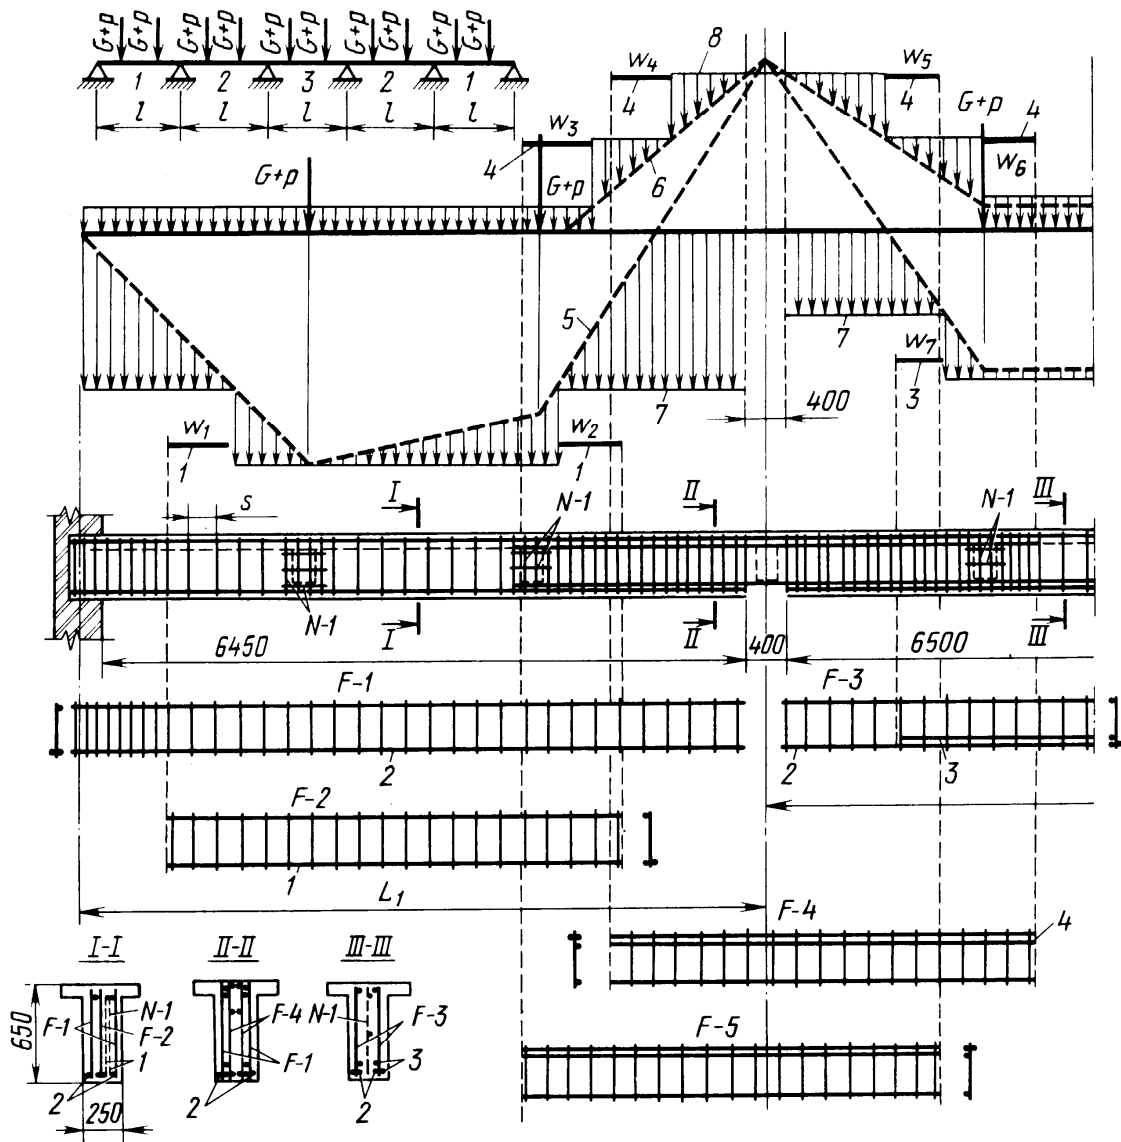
Розрахункова схема і варіант армування головної балки:
